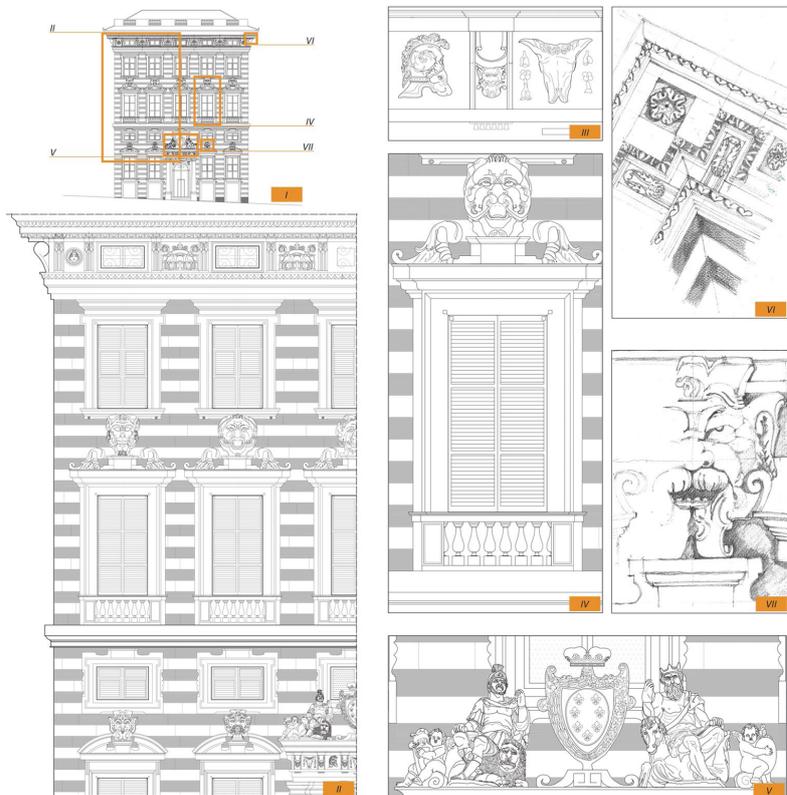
Restituzione a CAD e a mano libera dei particolari di facciata del Palazzo Fieschi-Ravaschieri. (Realizzazione dell'autore).
